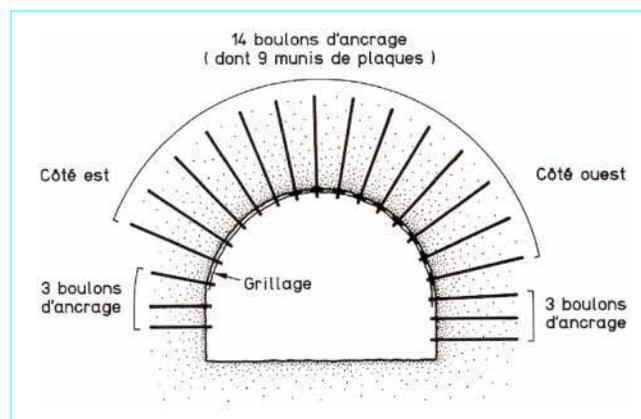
Soutènement par boulonnage. Section type d'une couronne
